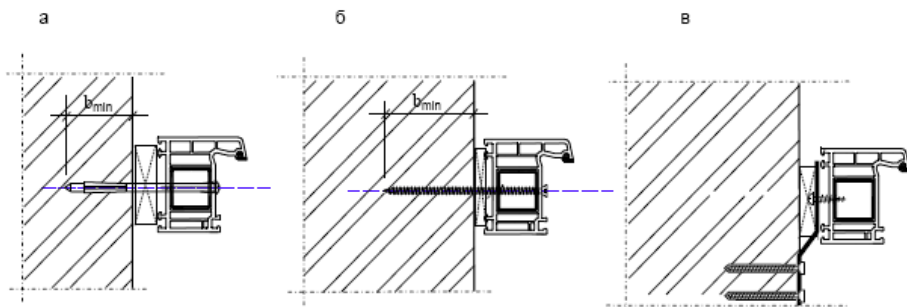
Варианты узлов монтажных креплений: а – распорным рамным дюбелем; б – строительным шурупом; в – гибкой анкерной пластиной
